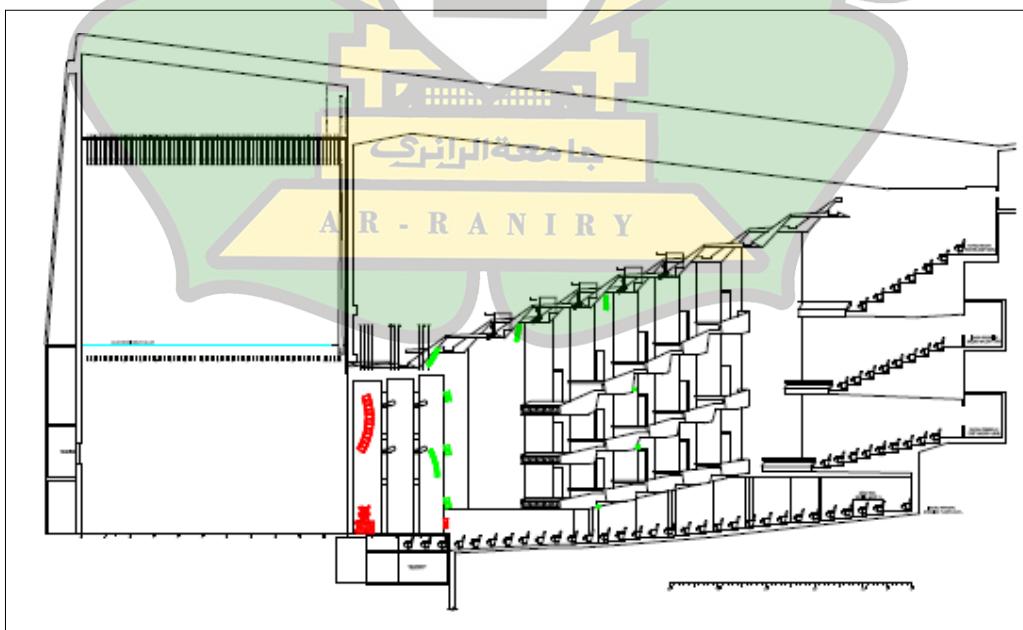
Foto Salle Wilfrid-Pelletier
